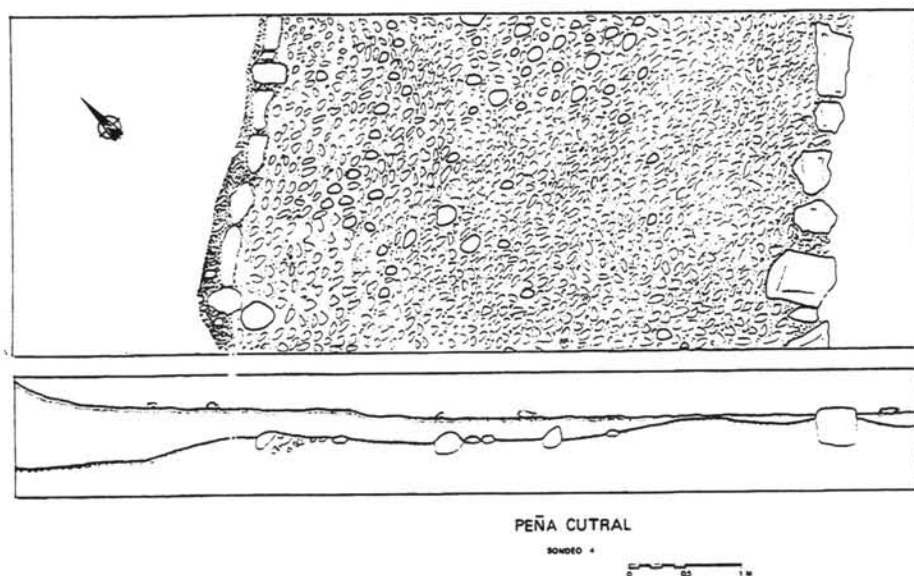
Planimetría y alzado del resto viario descubierto en el Sondeo 4.
